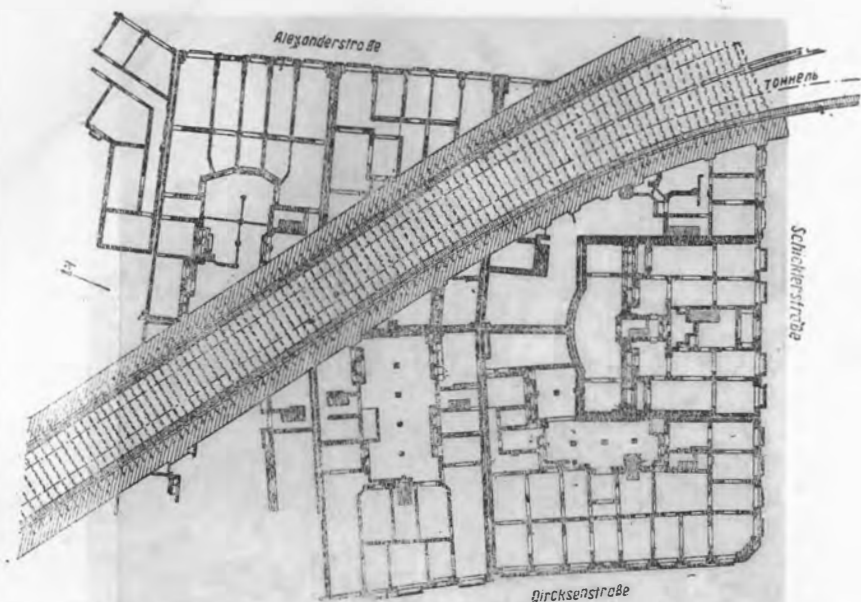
Проходка двухпутного тоннеля метро под блоком домов. План.
